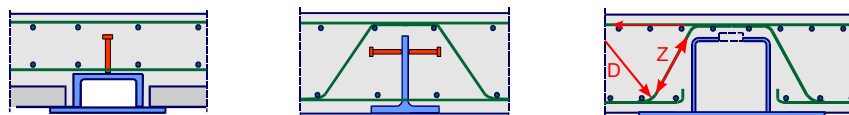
Direkte Einleitung der Deckenauflagerkräfte in das Stahlprofil
